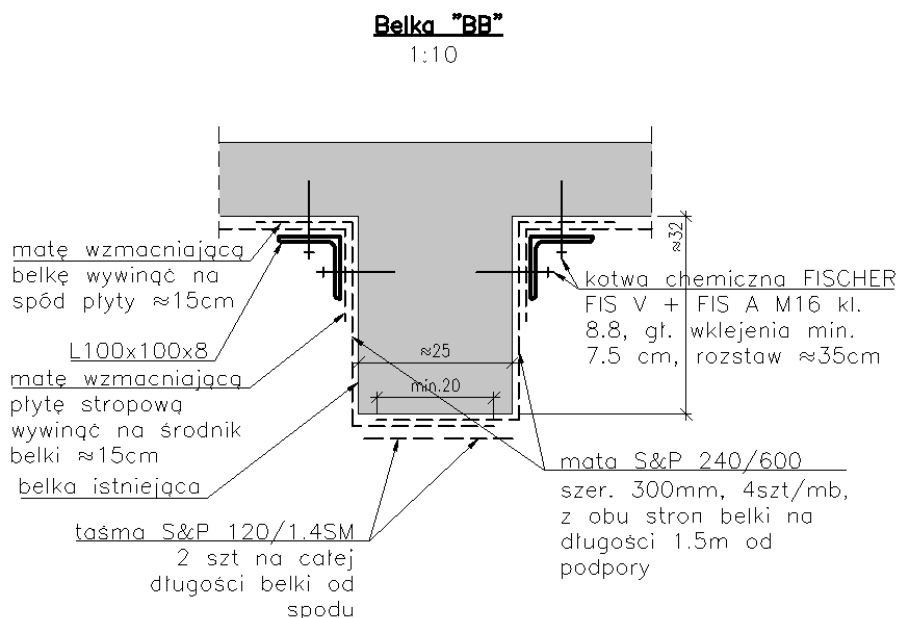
Detal wzmocnienia konstrukcji żelbetowej za pomocą profili stalowych c.d.
